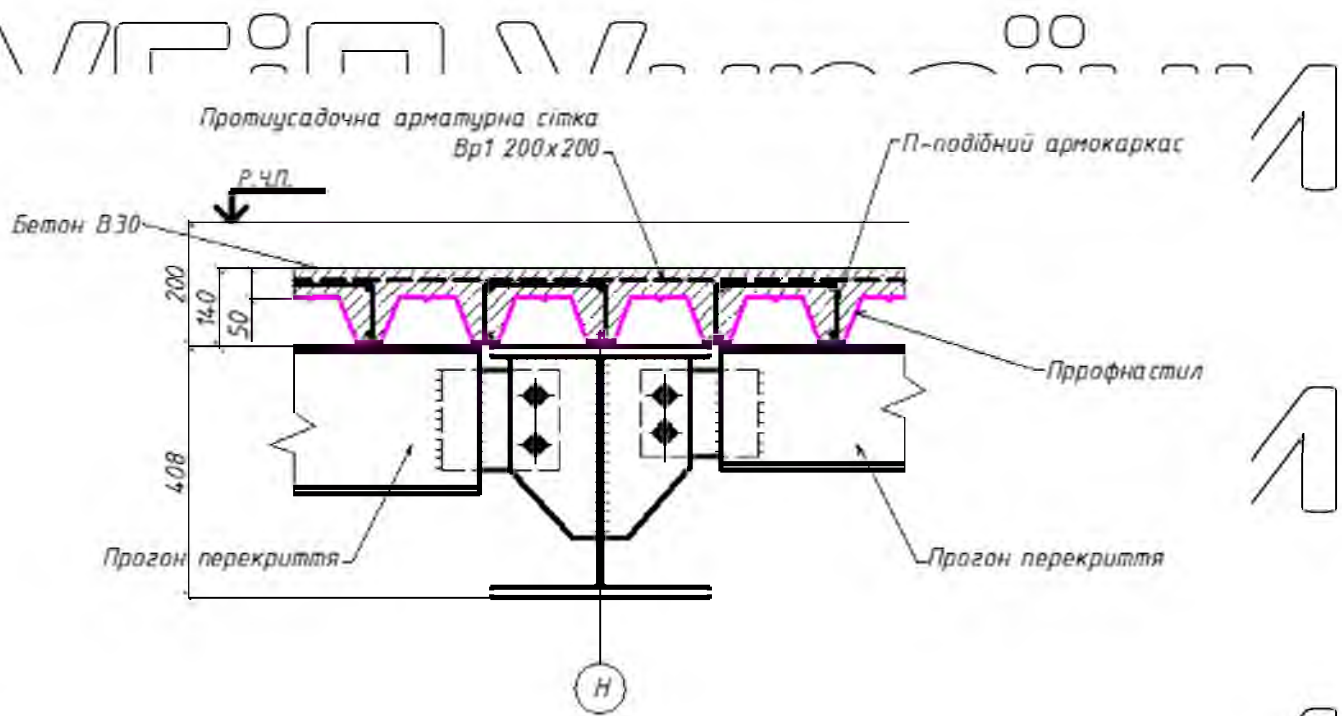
Фрагмент монолітної залізобетонної плити перекриття по профільованому металевому настилу
